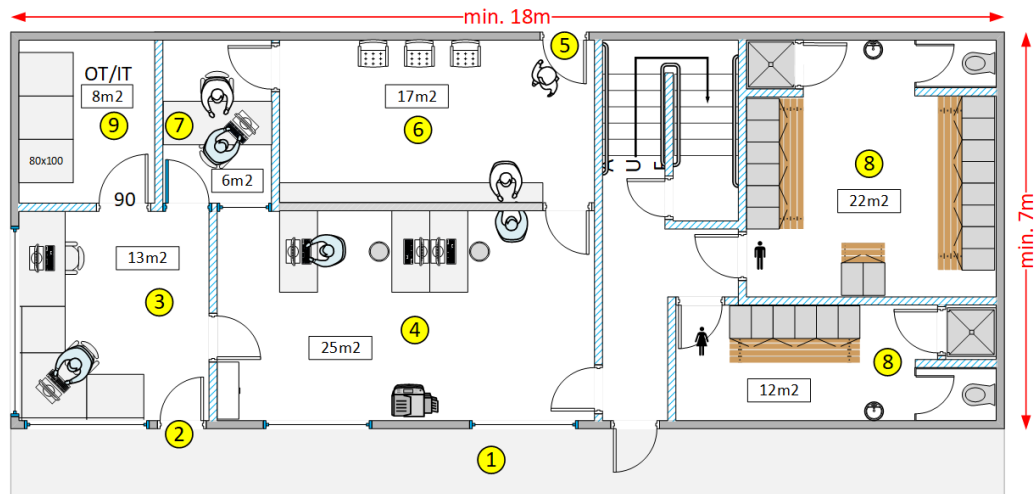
Grundriss Muster Bürogebäude EG
